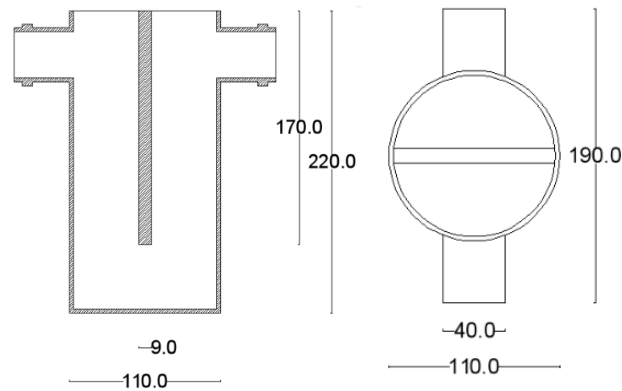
Concepção – Protótipo 3 (a) Corte transversal, (b) Planta
